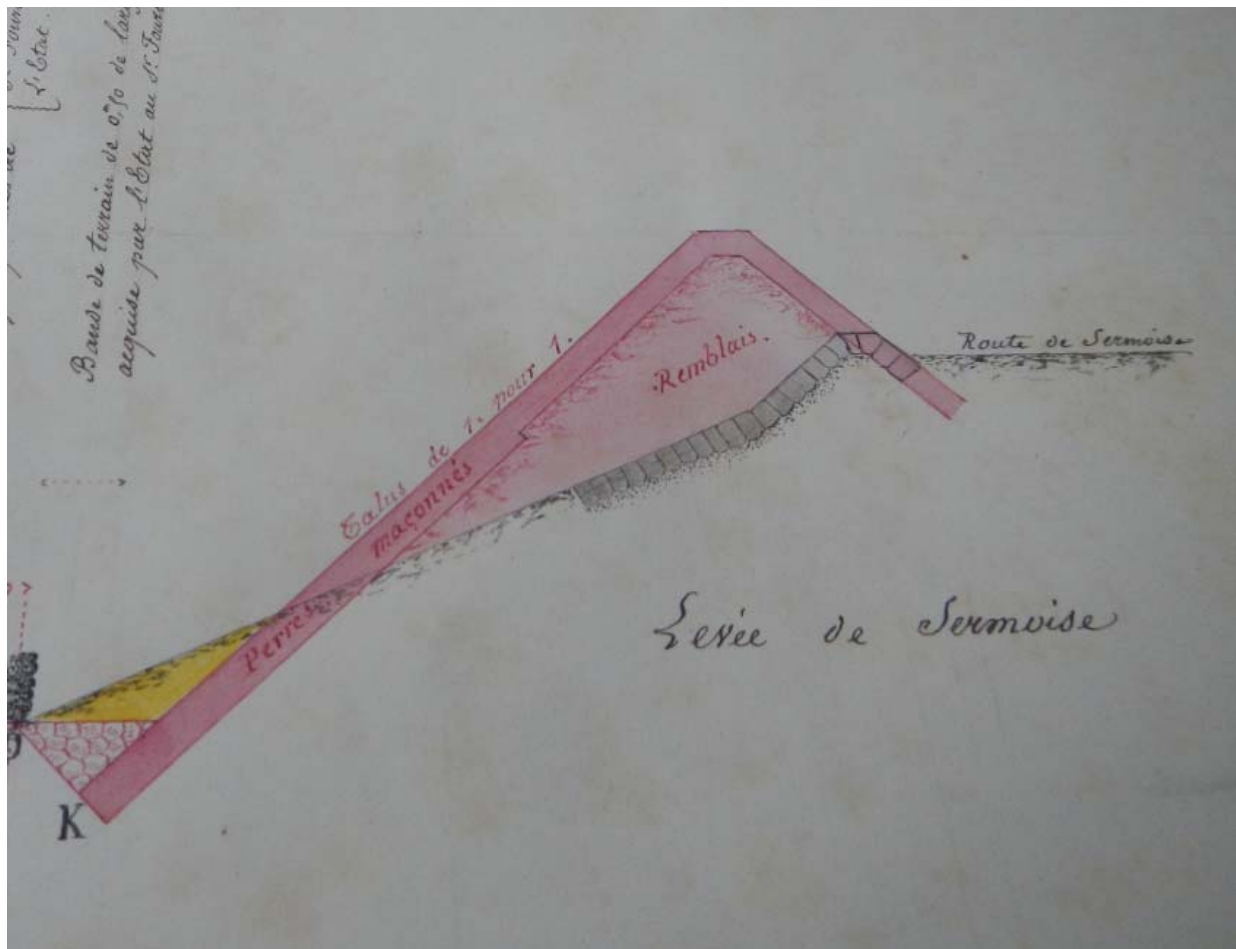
Profil type de la levée de Sermoise 1^{re} section avant et après travaux d'exhaussement et de consolidation, exécutés entre 1879 et 1882 – Source : Archives DDT 58
